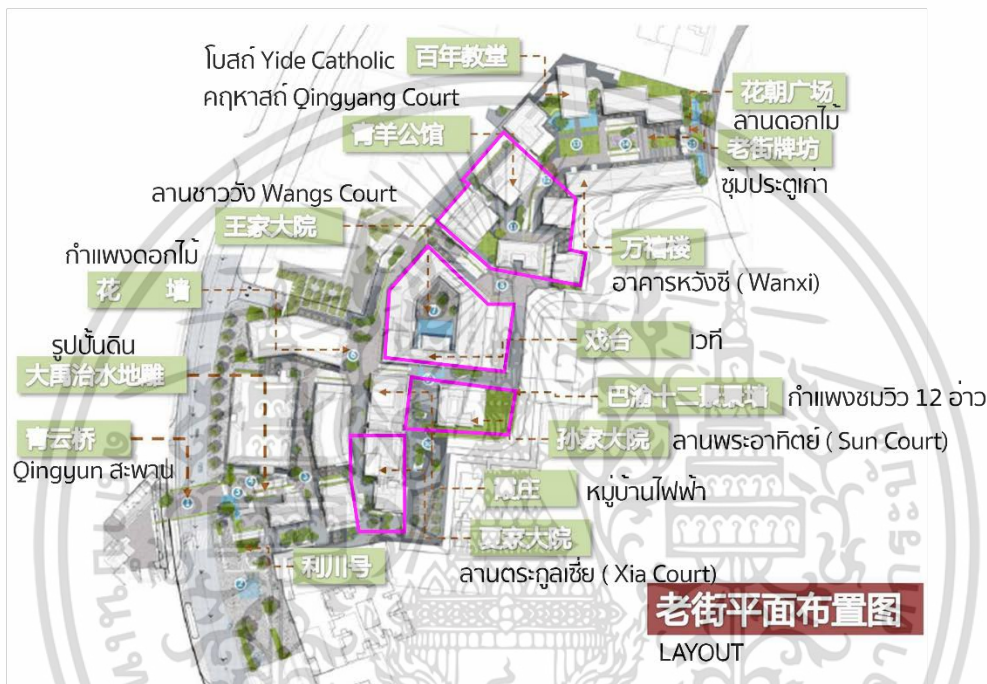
ถนนในโครงการ Danzishi Old Street
